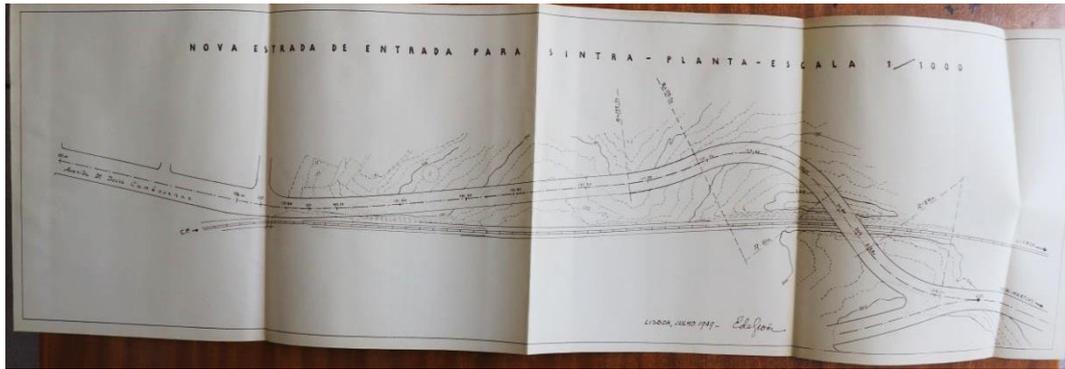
Nova Estrada de Entrada para Sintra - Planta de Estrada.
